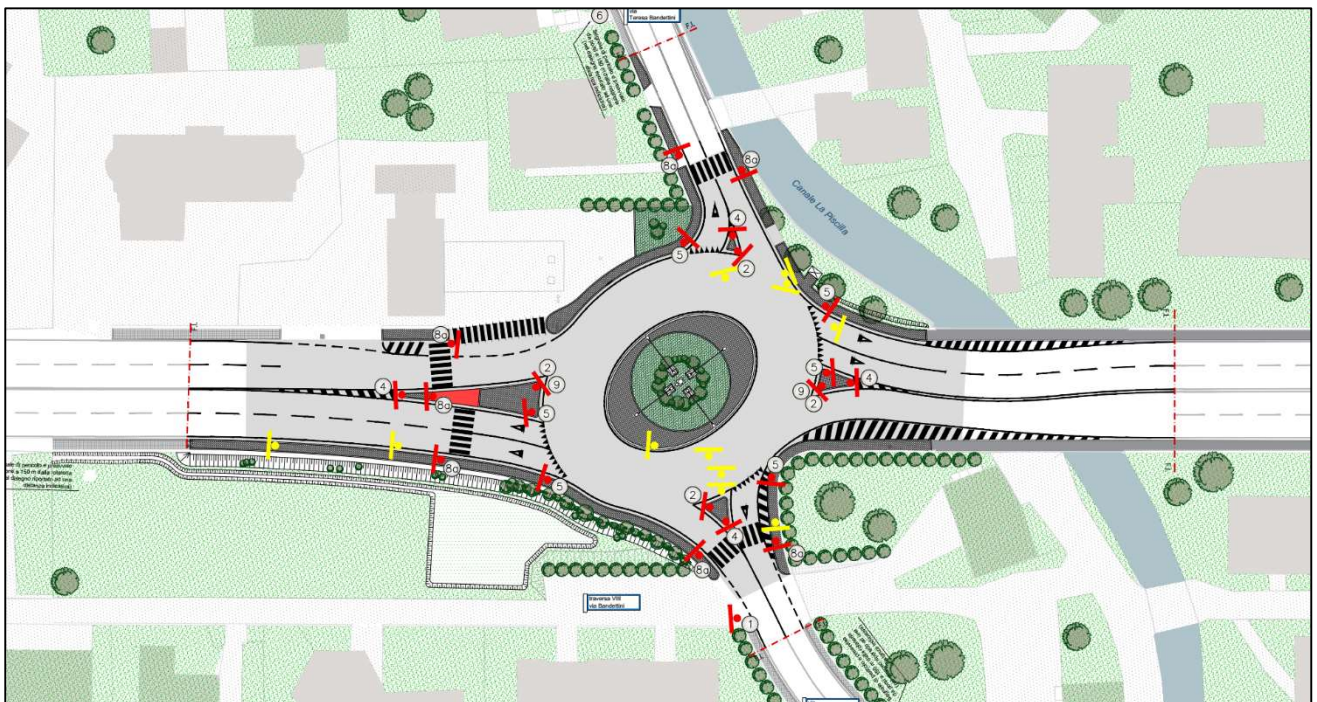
Stralcio della planimetria segnaletica orizzontale e verticale
